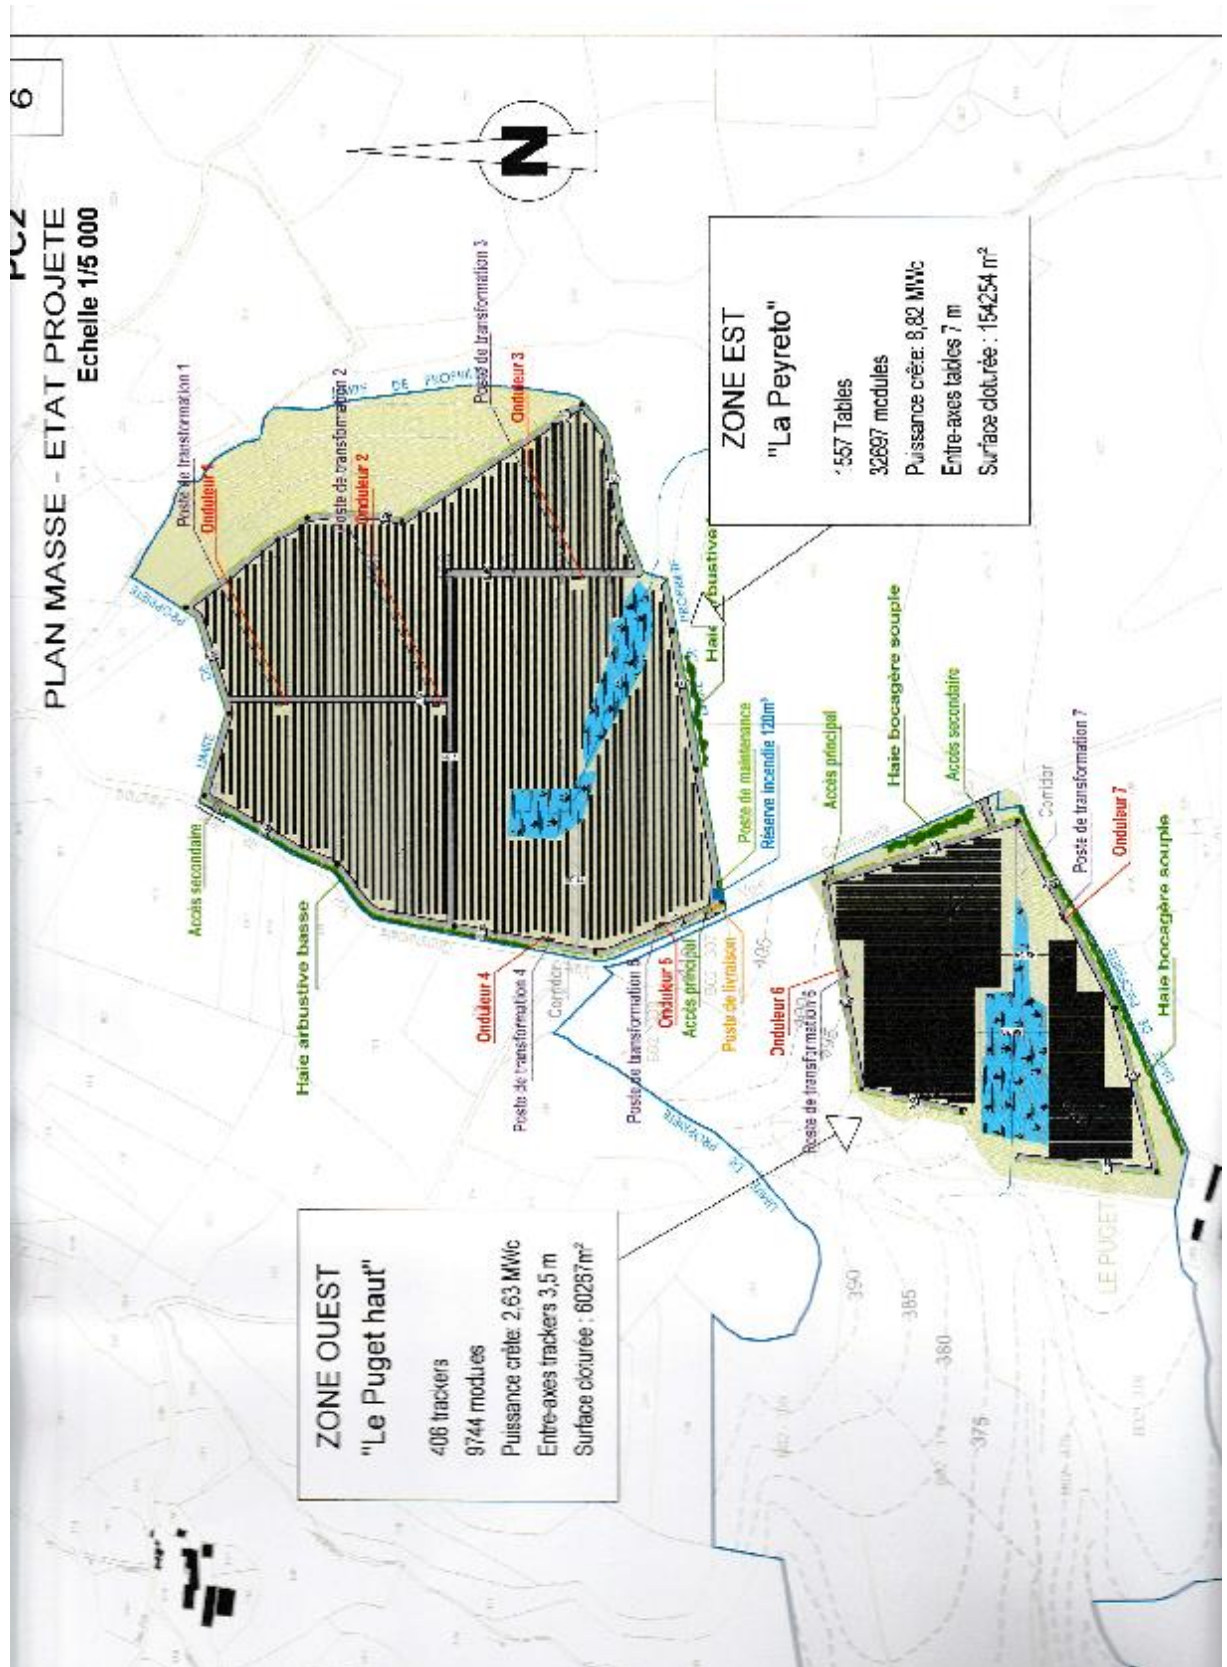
PLAN MASSE du projet de parc solaire : zone Ouest et zone Est
